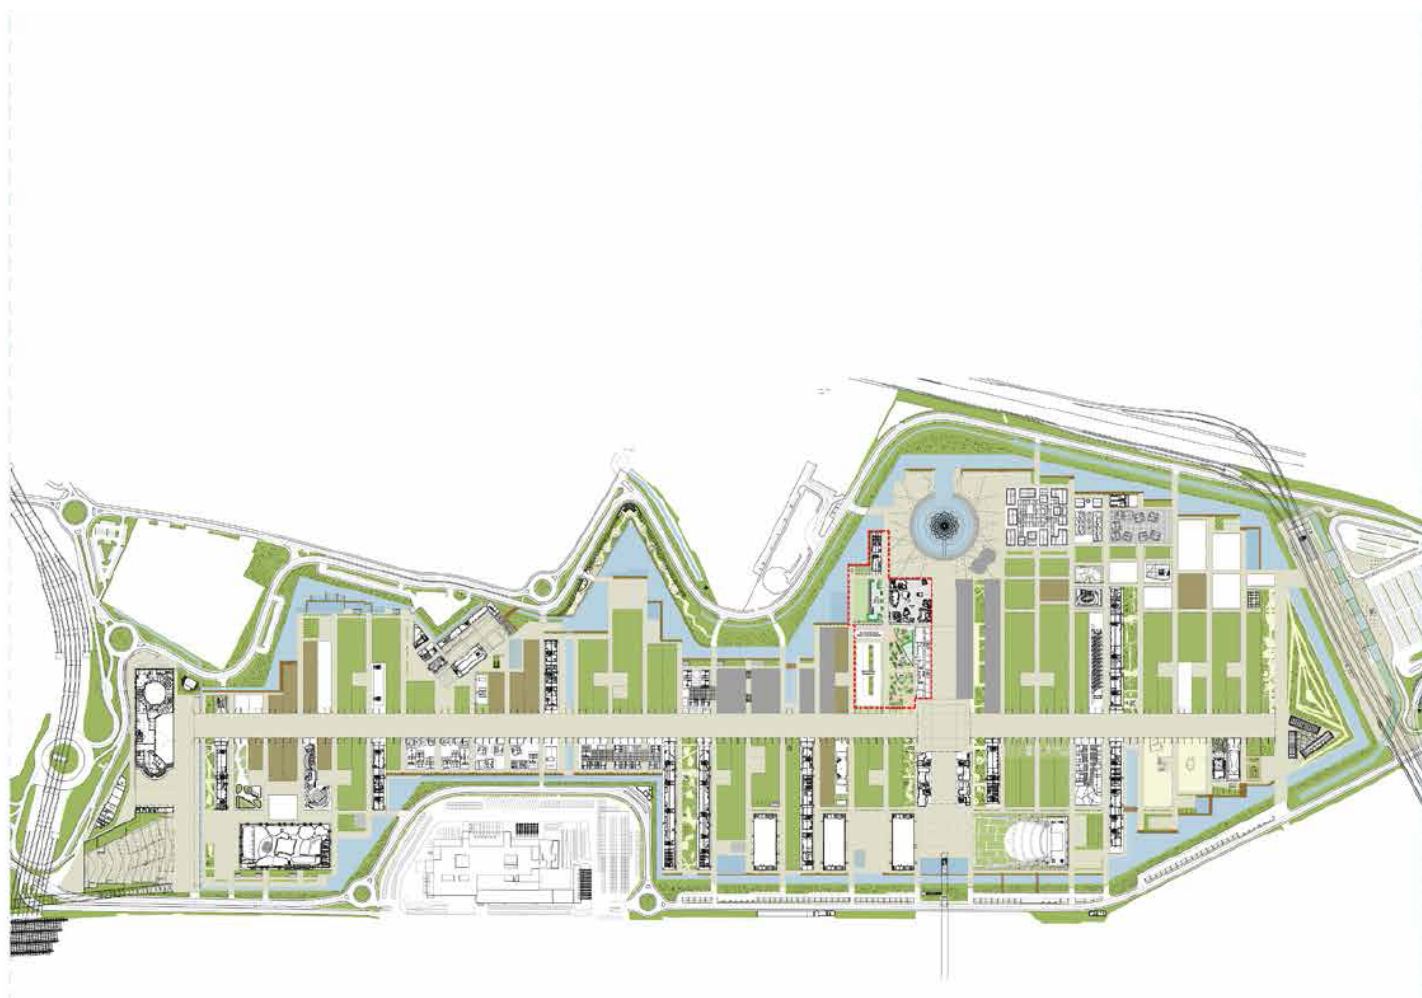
Planimetria dell'insediamento del progetto Human Technopole
